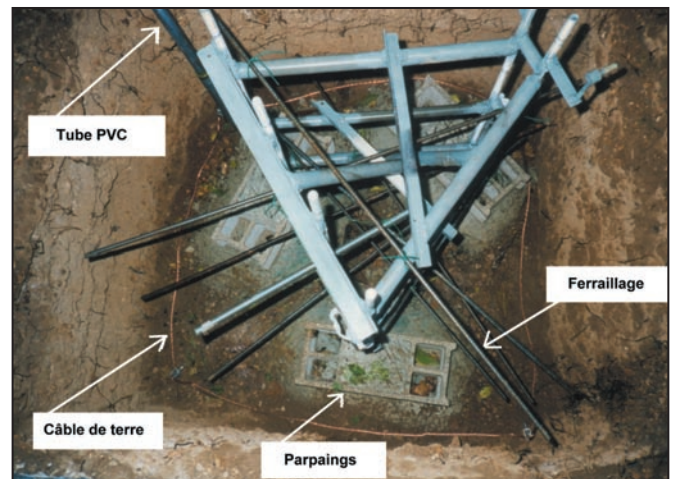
Prise de terre, ferrailage, et réglage de la chaise.
